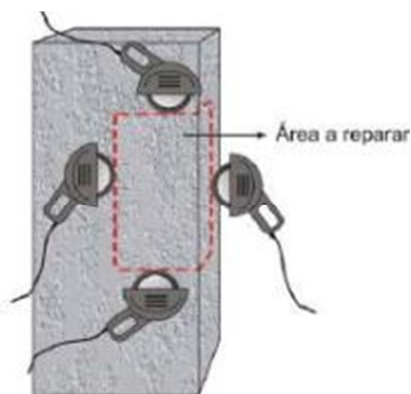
Corte em parede de concreto para delimitação da área para intervenção
